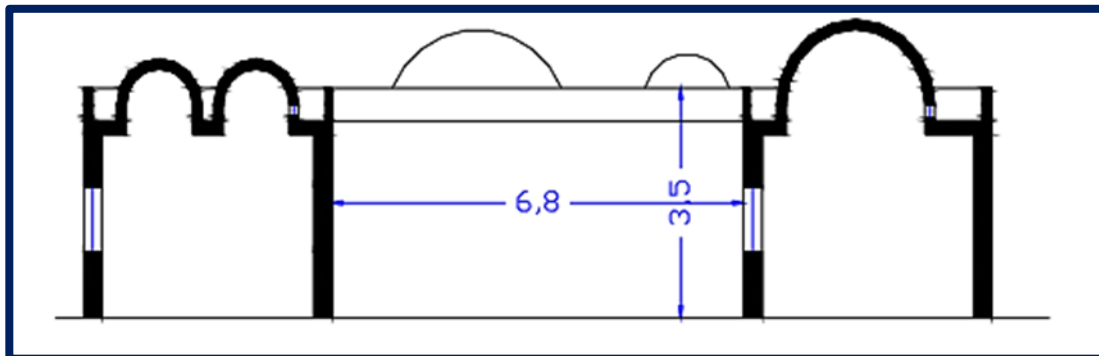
Coupe sur la maison montrant la dimension de la cour
